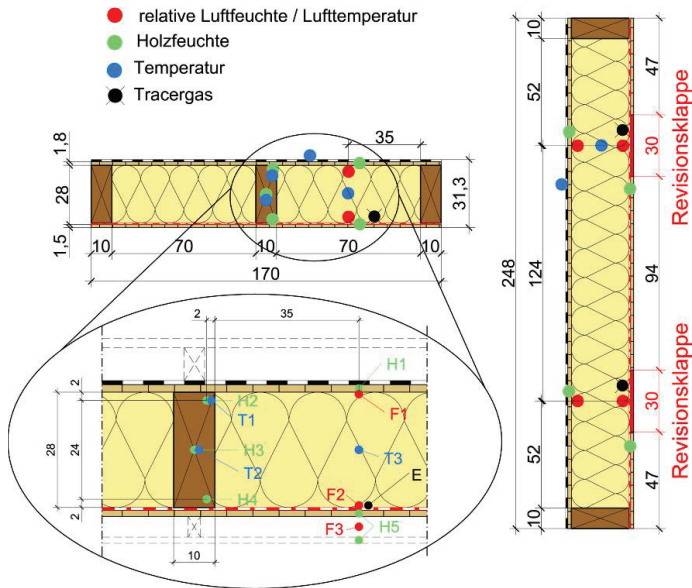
Schematische Darstellung der untersuchten Dachelemente 1 bis 7 mit Abmessungen der Dachelemente und Positionen der Messstellen;
